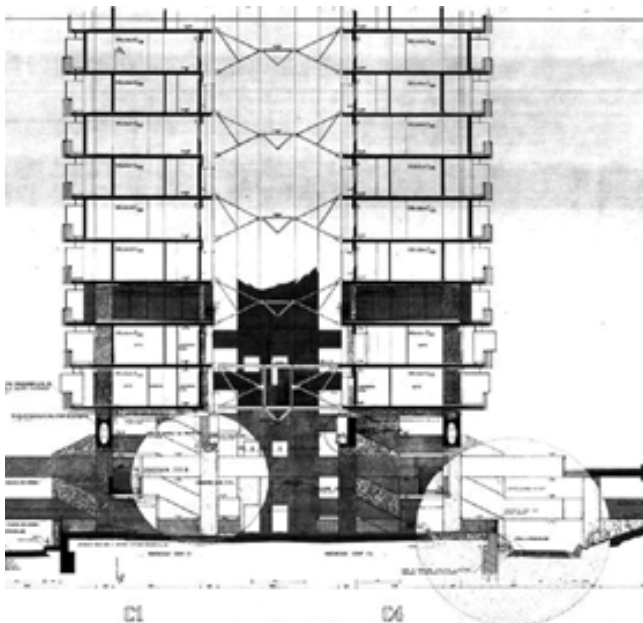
Sezione tipo sul percorso pensile centrale della tipologia a tenda come pensata da Di Salvo
